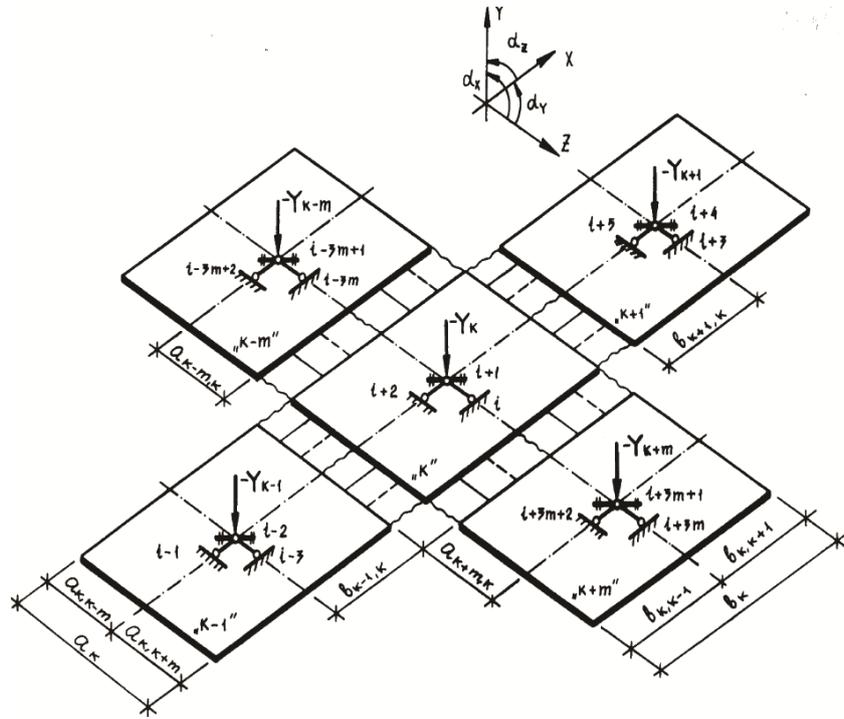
Изгибаемая железобетонная конструкция, связи метода перемещений для плосконапряженного состояния конструкций
